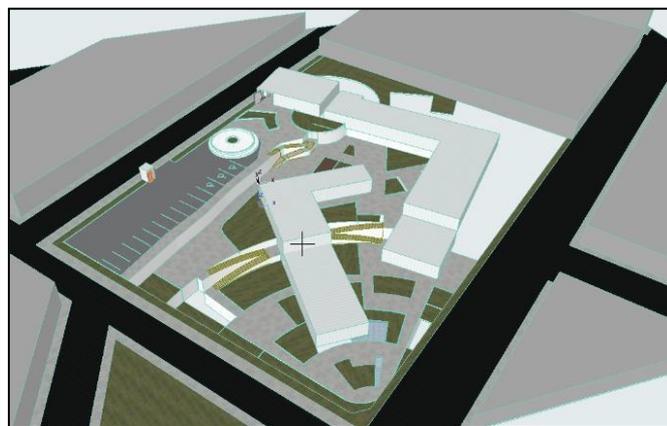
Vista de Planta del proyecto con sus zonas recreacionales
